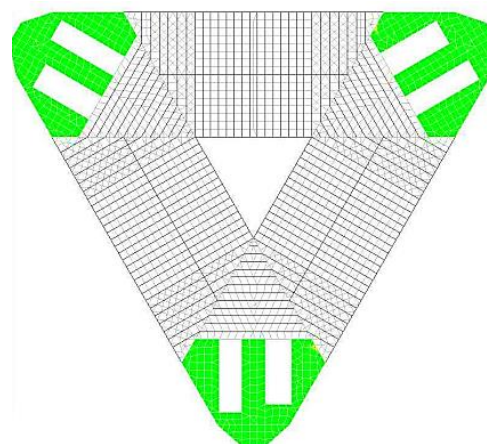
Діаметри нижньої арматури плит перекриття ядер жорсткості по осі Y крок 200 мм
